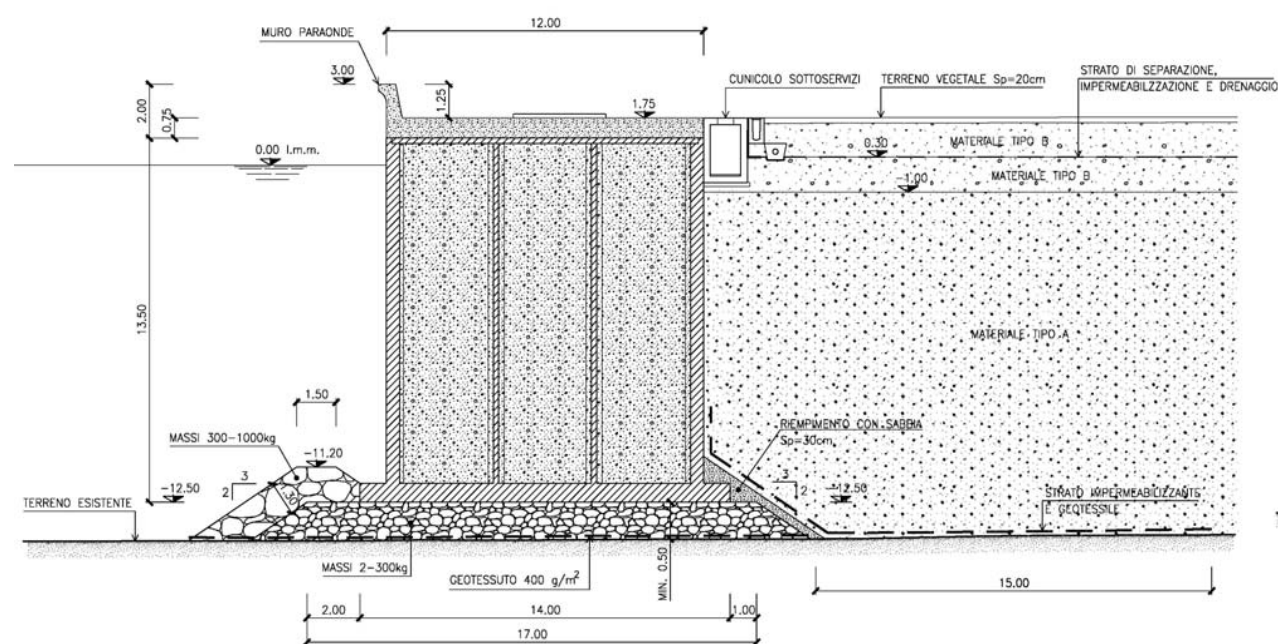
Opera a mare nel Canale di Calma - Sezione tipo
